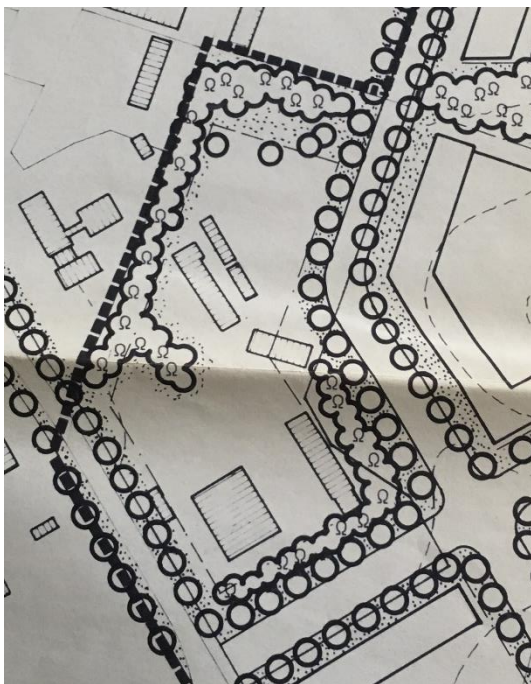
Konzeption des Grünordnungsplans mit einreihiger Baumreihe (wie Bestand) zur Berliner Straße
